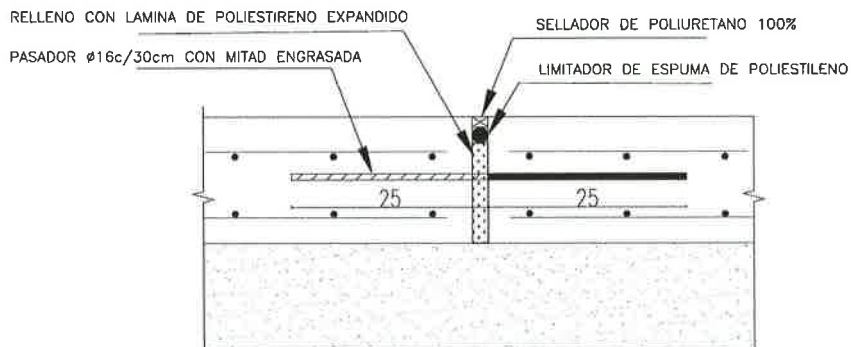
Juntas de dilatación en pisos de hormigón armado con pasadores.
